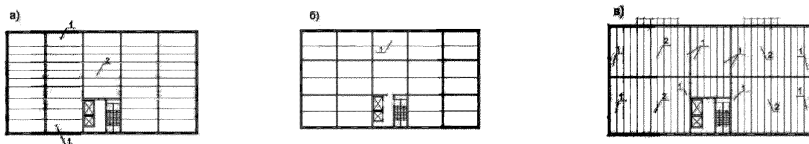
Схема расположения плит перекрытий: а) поперечно-стенная система; б) перекрестно-стенная система; в) продольно-стенная система; 1 – перекрытия, опирающиеся по трем сторонам; 2 – перекрытия, опирающиеся по двум сторонам
